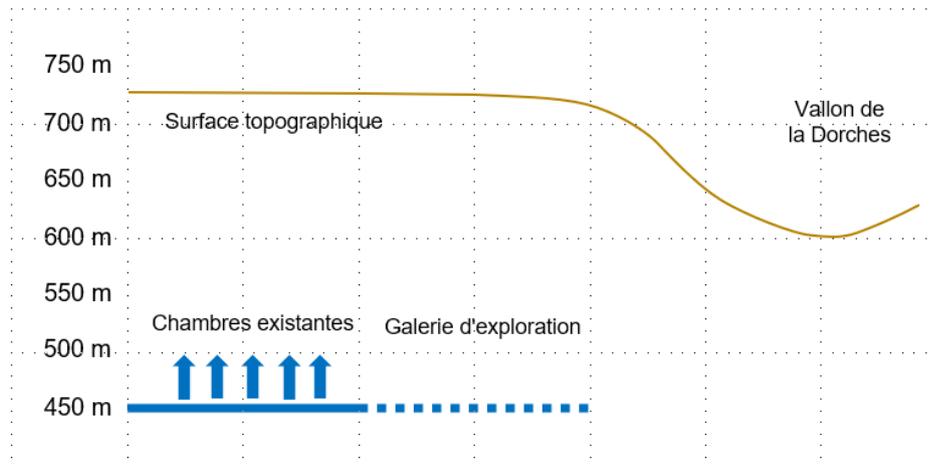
Schéma de la situation topographique de la mine et la galerie de reconnaissance
